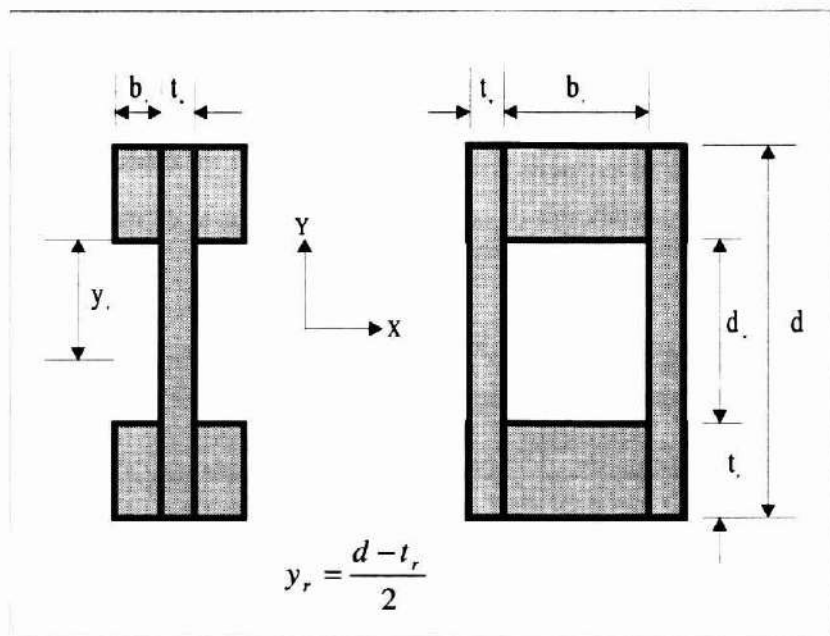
GEOMETRÍA DE LAS SECCIONES TRANSVERSALES.
